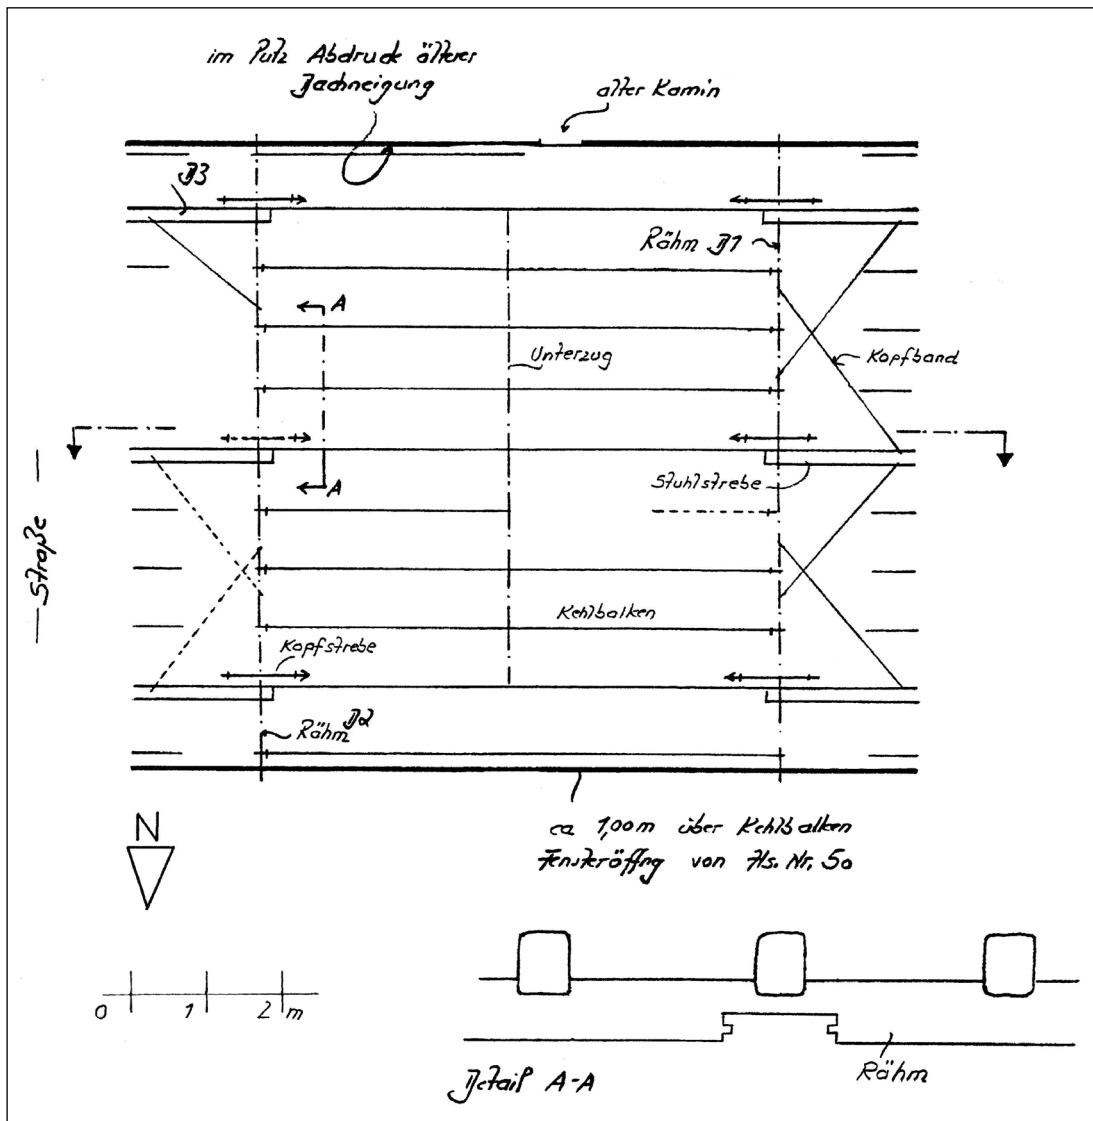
Hauptstraße 50, Grundriss 1. Dachgeschoss.
